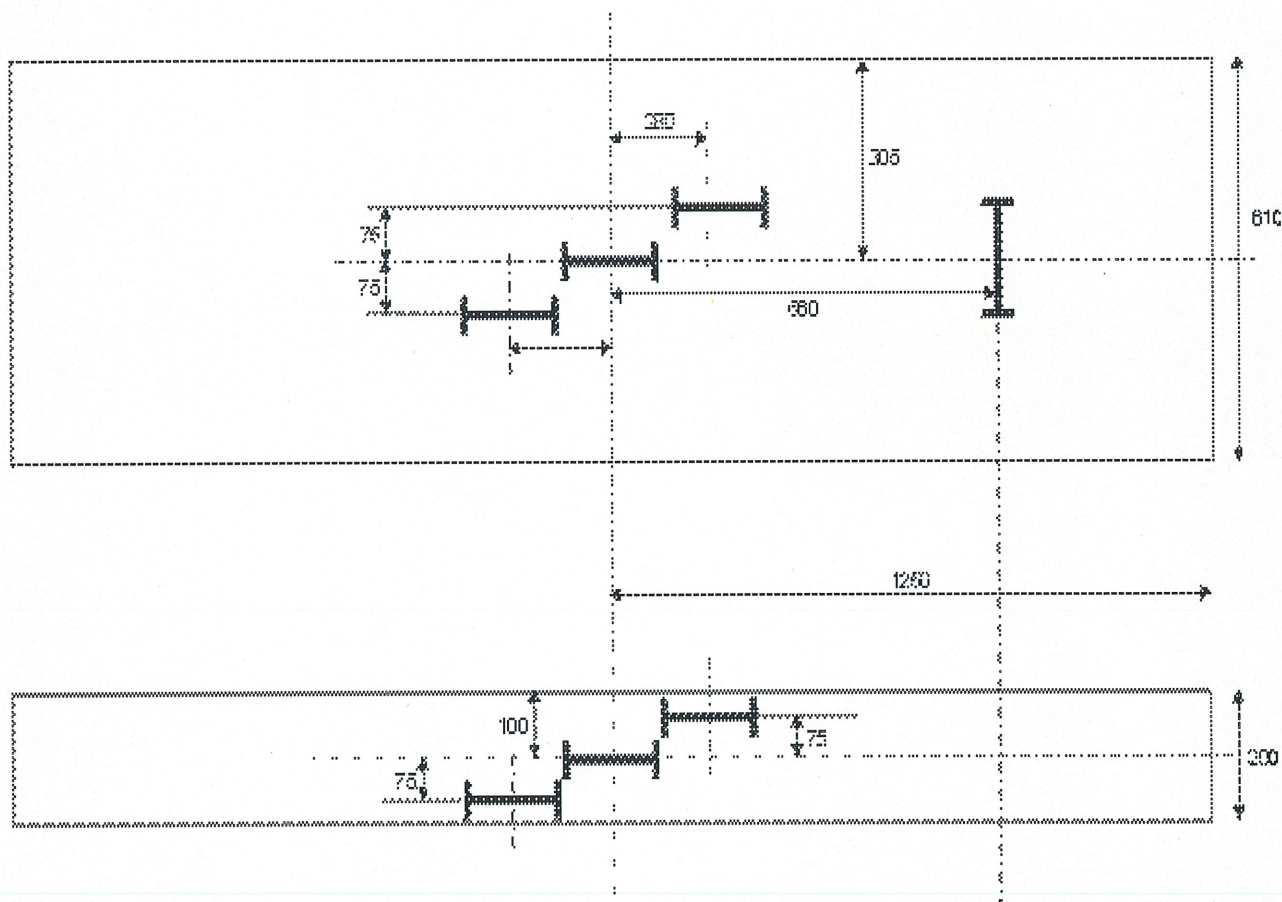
Vues en plan et en élévation de la position des instruments dans les dalles
